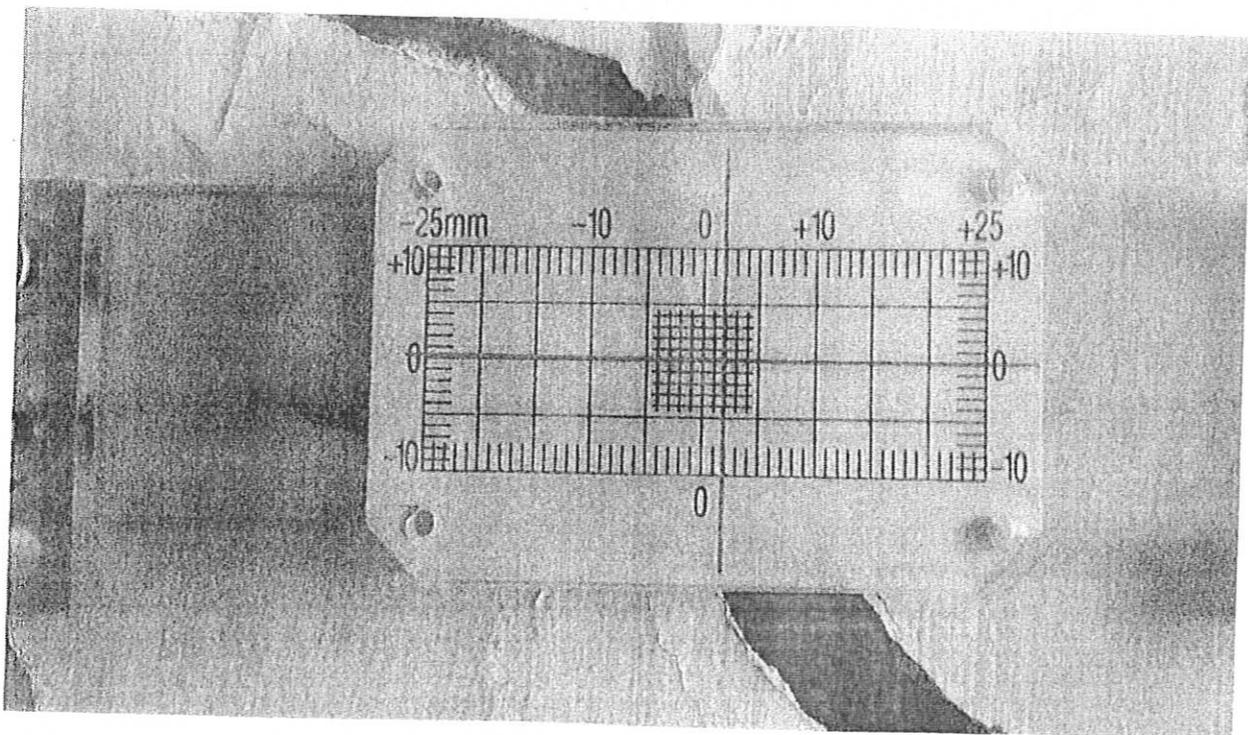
Fessurimetro nella zona angolare nord-ovest del complesso
